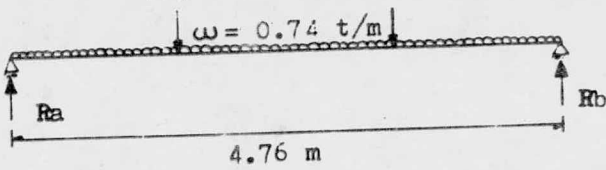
b).- Reacciones de Vigas del Fondo Mojado
